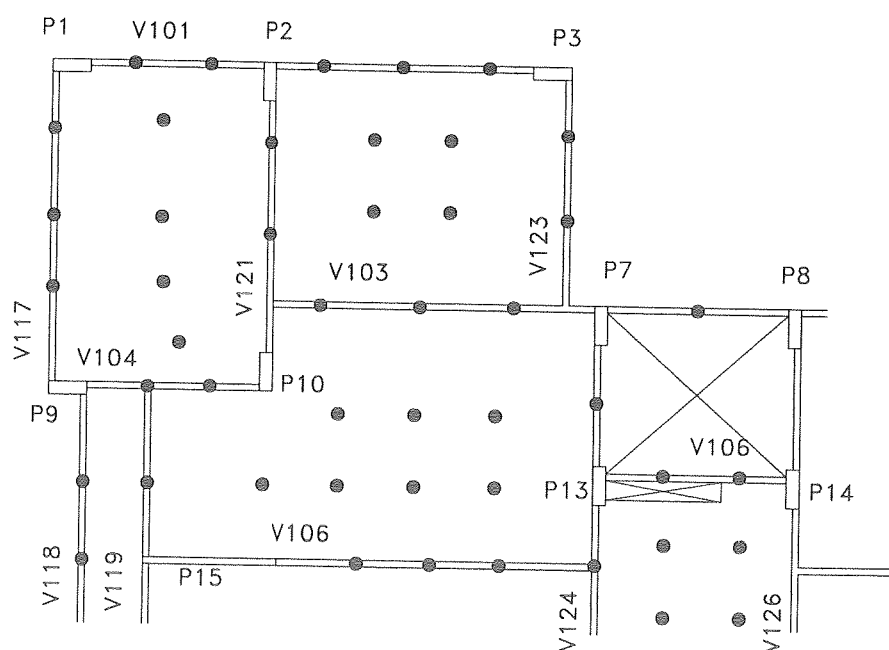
Pavimento Analisado e Posicionamento dos Escoramentos
